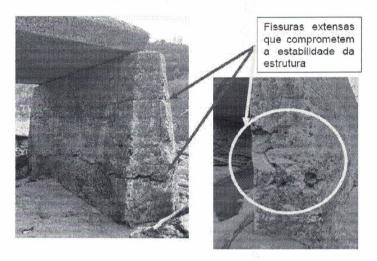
Fissura Trasnversal no Pilar 7
